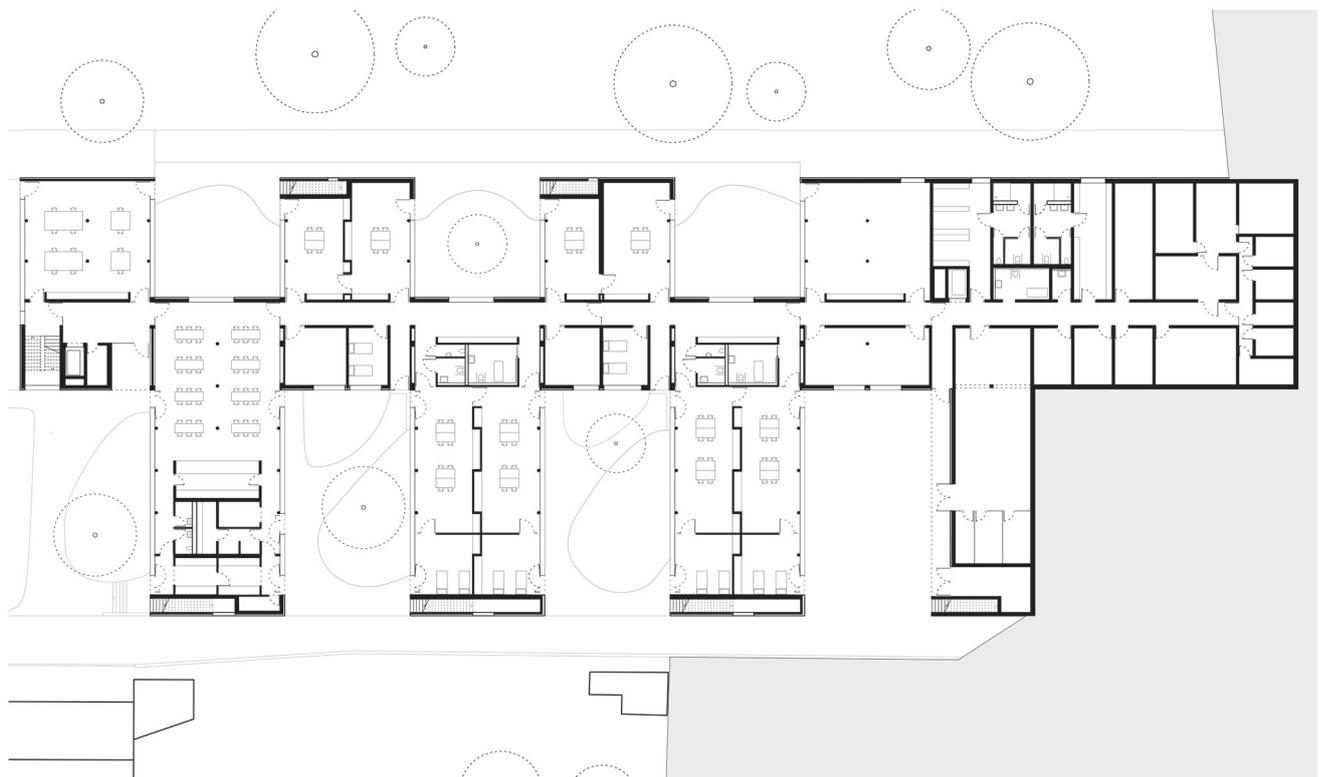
Grundriss Eingang Werkstatt für behinderte Menschen
